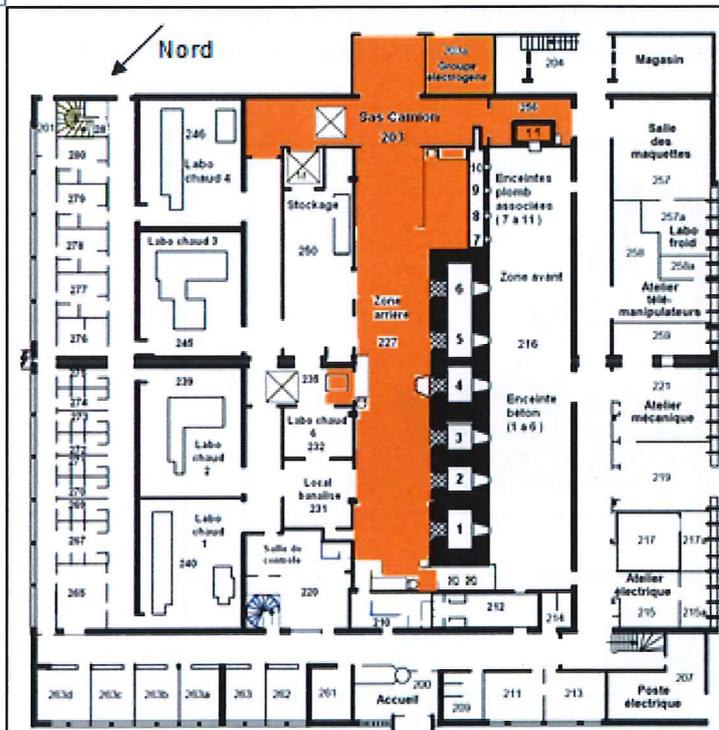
Plan du rez de chaussée de l'INB 61 – Locaux concernés par le diagnostic de sol (en orange)
